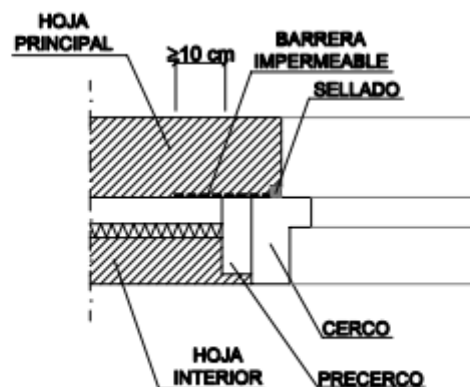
Ejemplo de encuentro de la fachada con la carpintería
